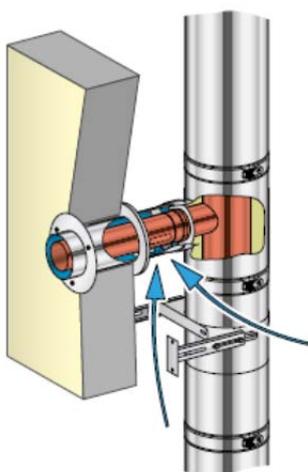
Mise en place des conduits de liaison, 3CE P MULTI+ à l'extérieur d'un bâtiment
